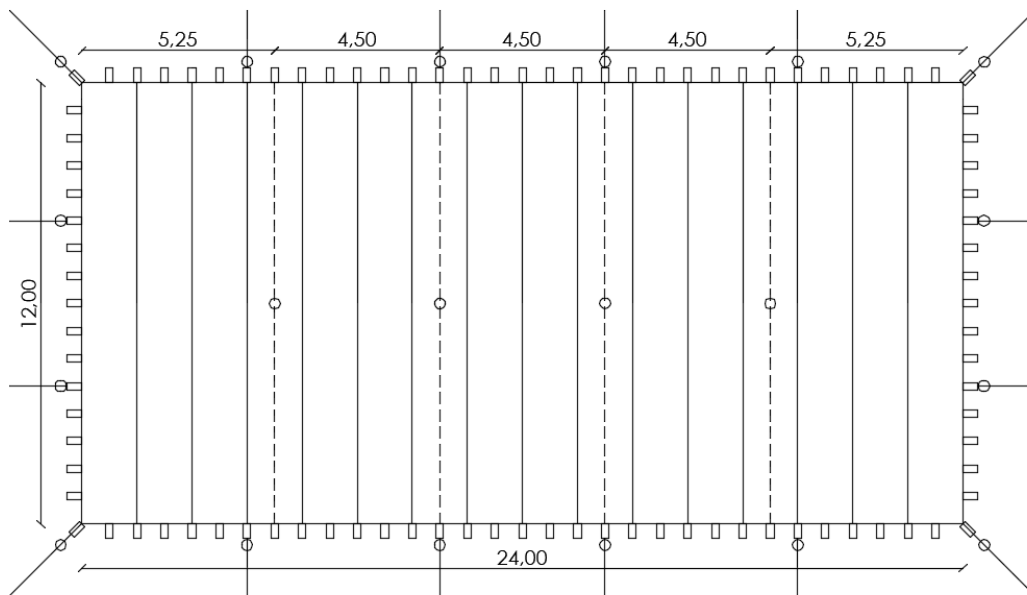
PLANTA CUERPO INDIVIDUAL DE CARPA
